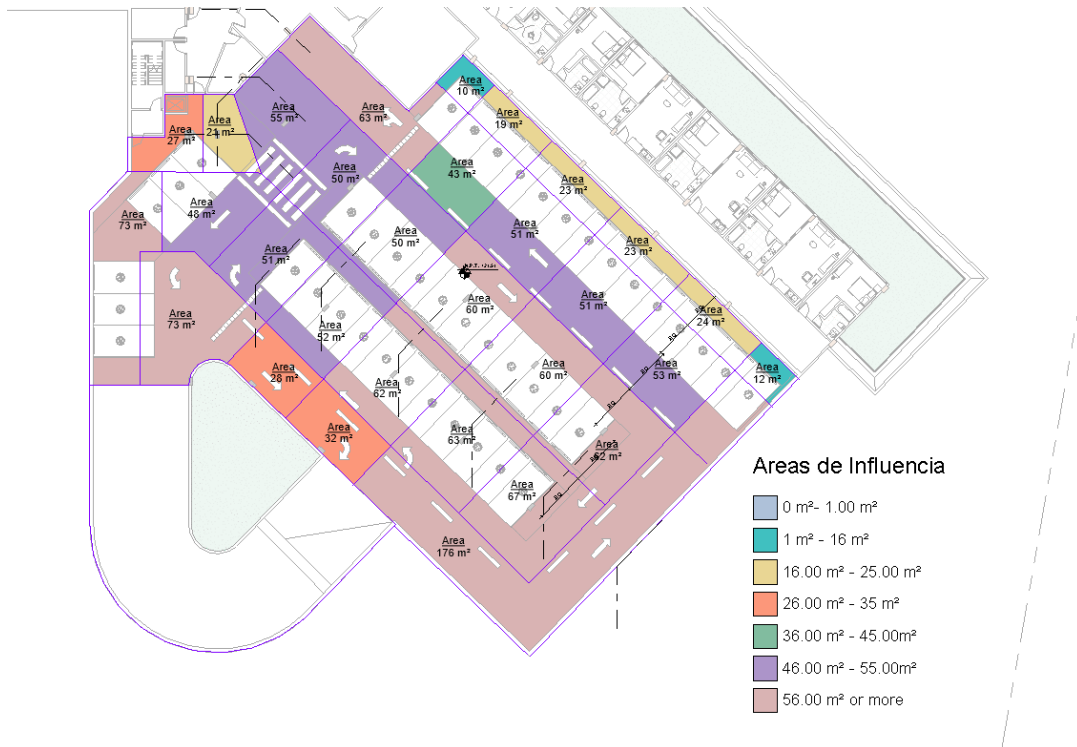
OBRAS DE CONCRETO ARMADO NIVEL -1
